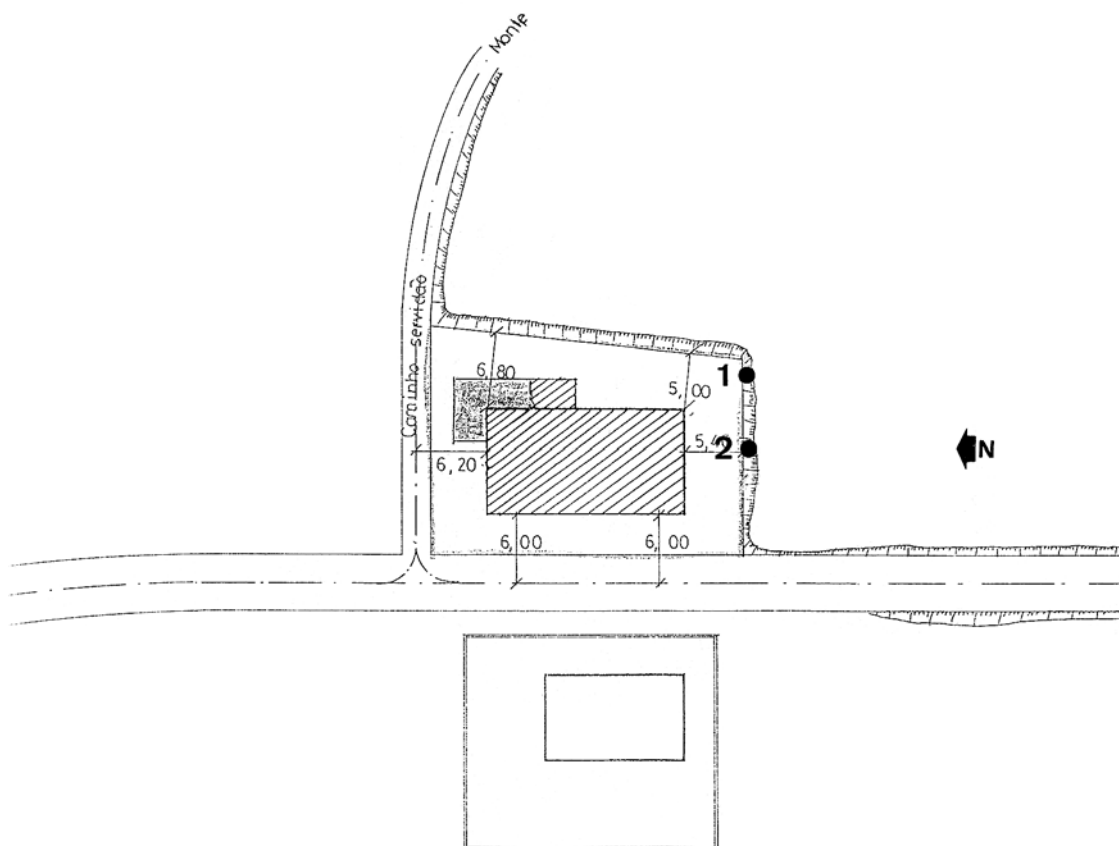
Planta da vivenda à escala 1:500, com localização das Fossas 1 e 2, intervencionadas em escavação.
